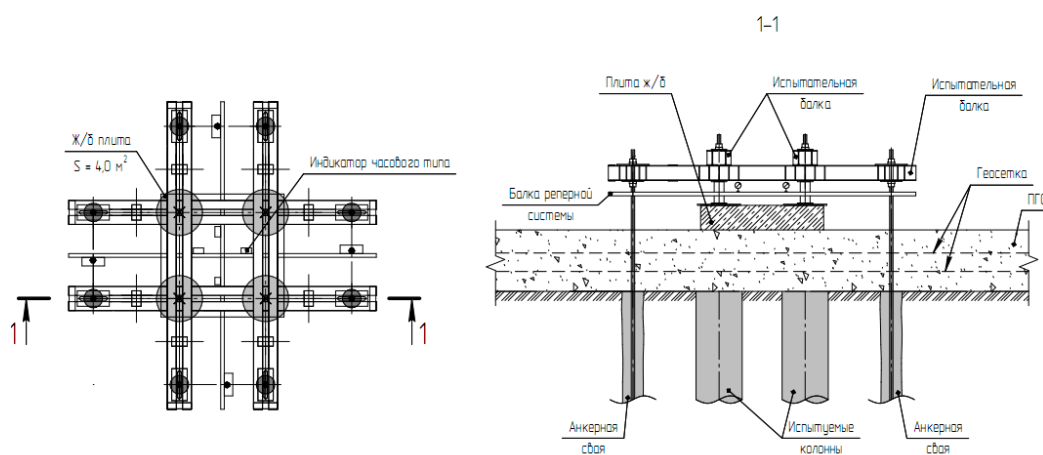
Схема испытания укрепленного грунта штампом для схемы укрепления № 1.
